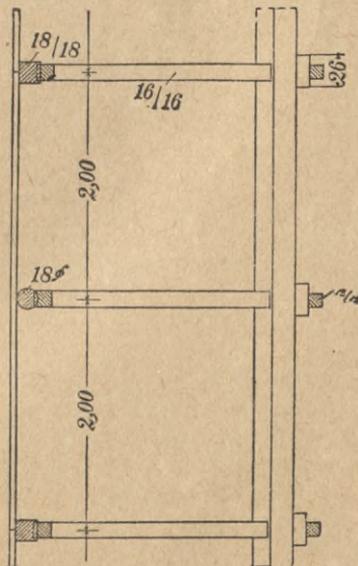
Absteifung einer freistehenden Baugrubenwand durch Pfähle und Schrägstößen oder Zangen.
